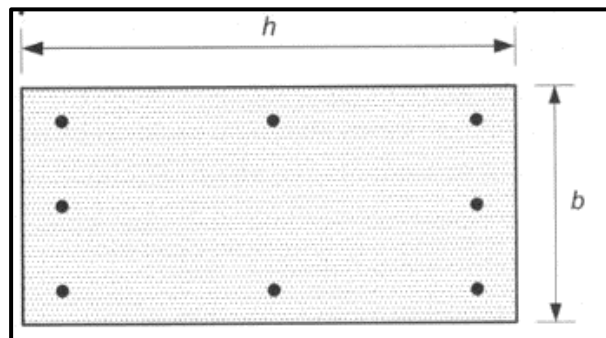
Sección de columna con acero presforzado (Naaman, 2004)
